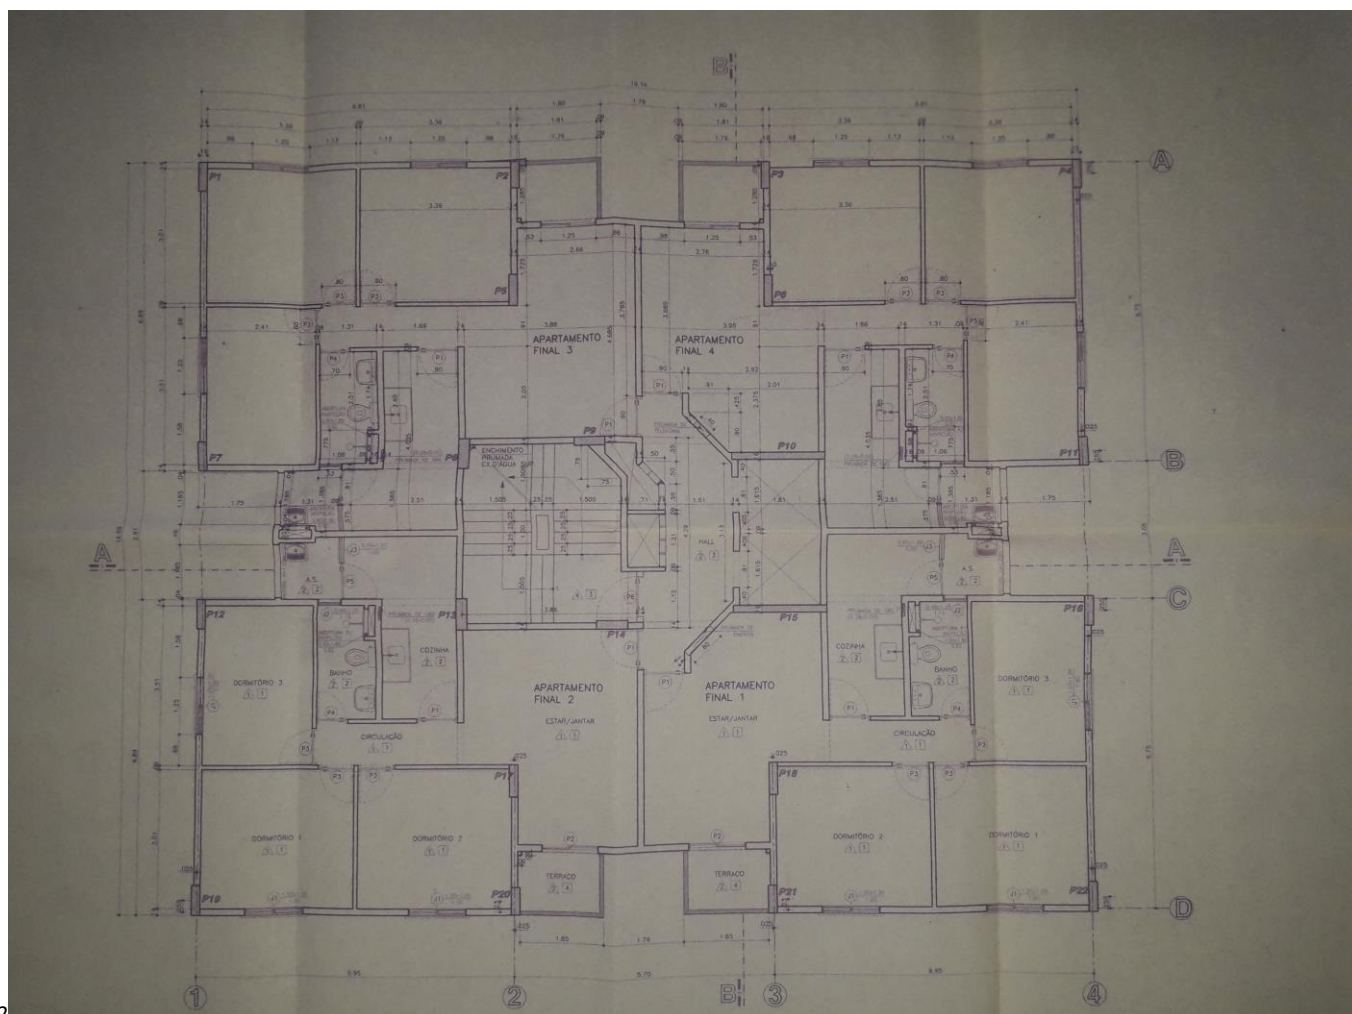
(ANEXO IV) – Planta baixa retratando as dependências do piso total, todas as prumadas (finais 1, 2, 3 e 4).
